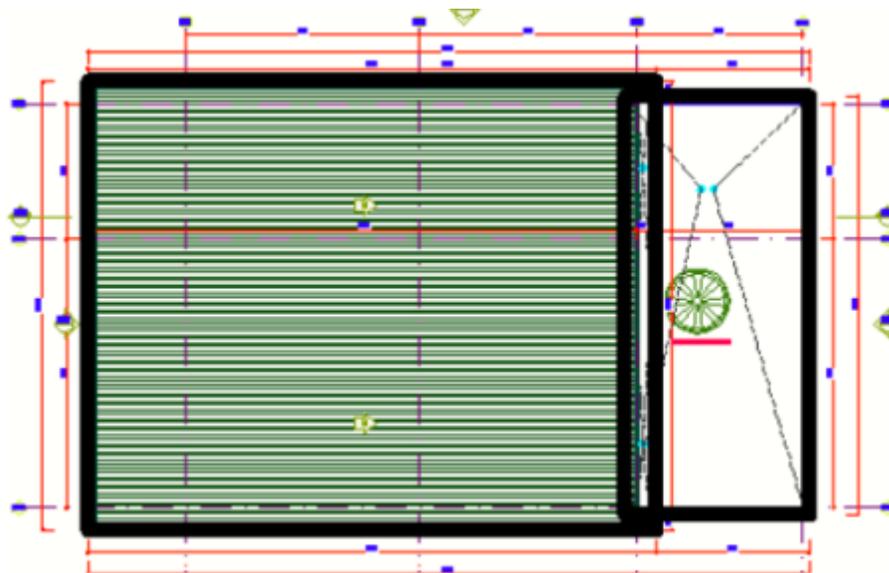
Planta de mecanización agrícola. Unión temporal SENA (2019).
